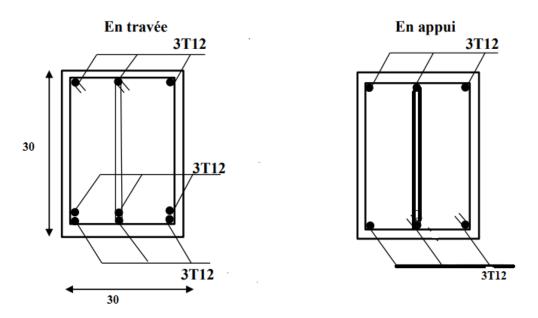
coupe de Ferraillage de la poutre palier.
